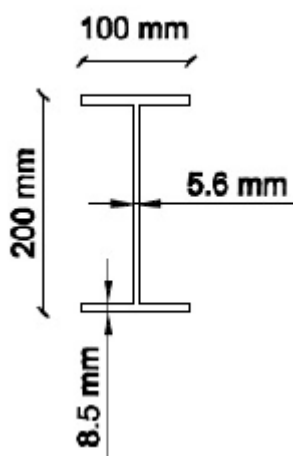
Geometria da secção transversal do perfil IPE200
